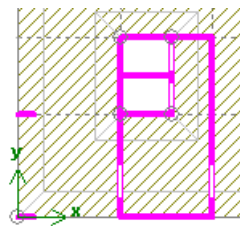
Плита перекрытия с отверстием (фрагмент)
